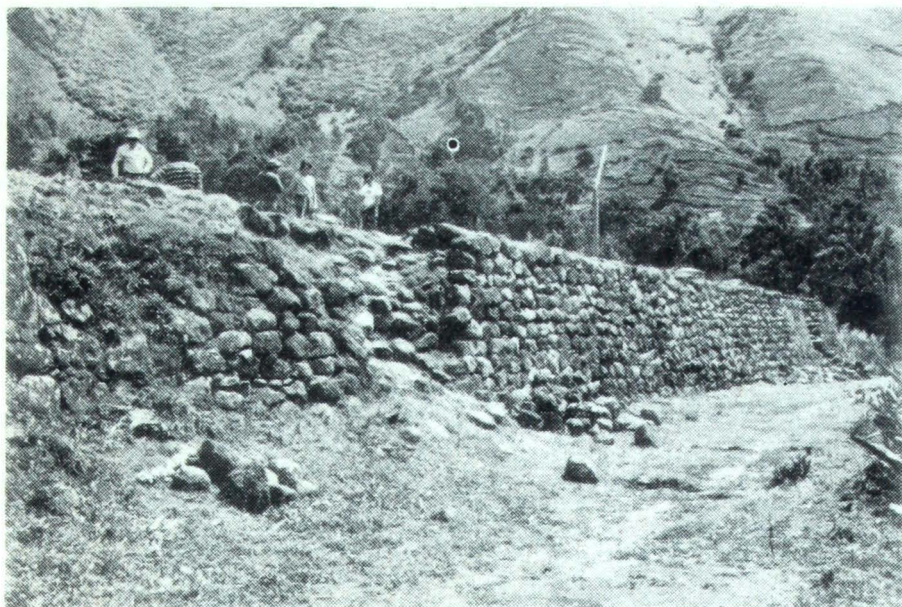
Trabajos de restauración de la muralla norte del fuerte Santa Bárbara.
